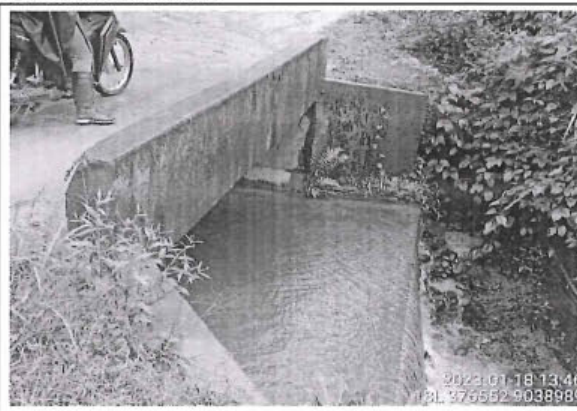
Alcantarilla de concreto en buen estado y buen funcionamiento ubicado en la progresiva 6+798.
